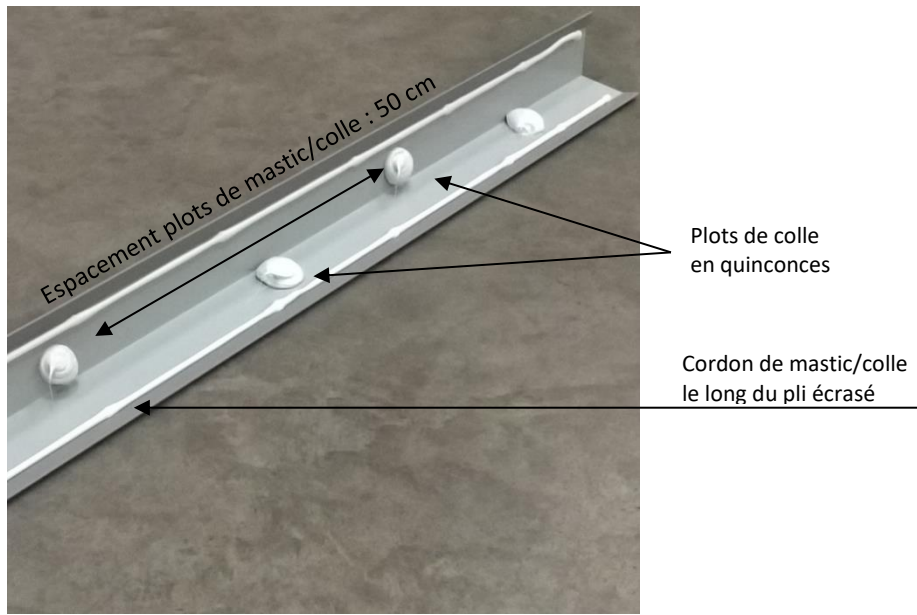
Exemple : Pose verticale des panneaux Myral sur support plateaux métalliques
